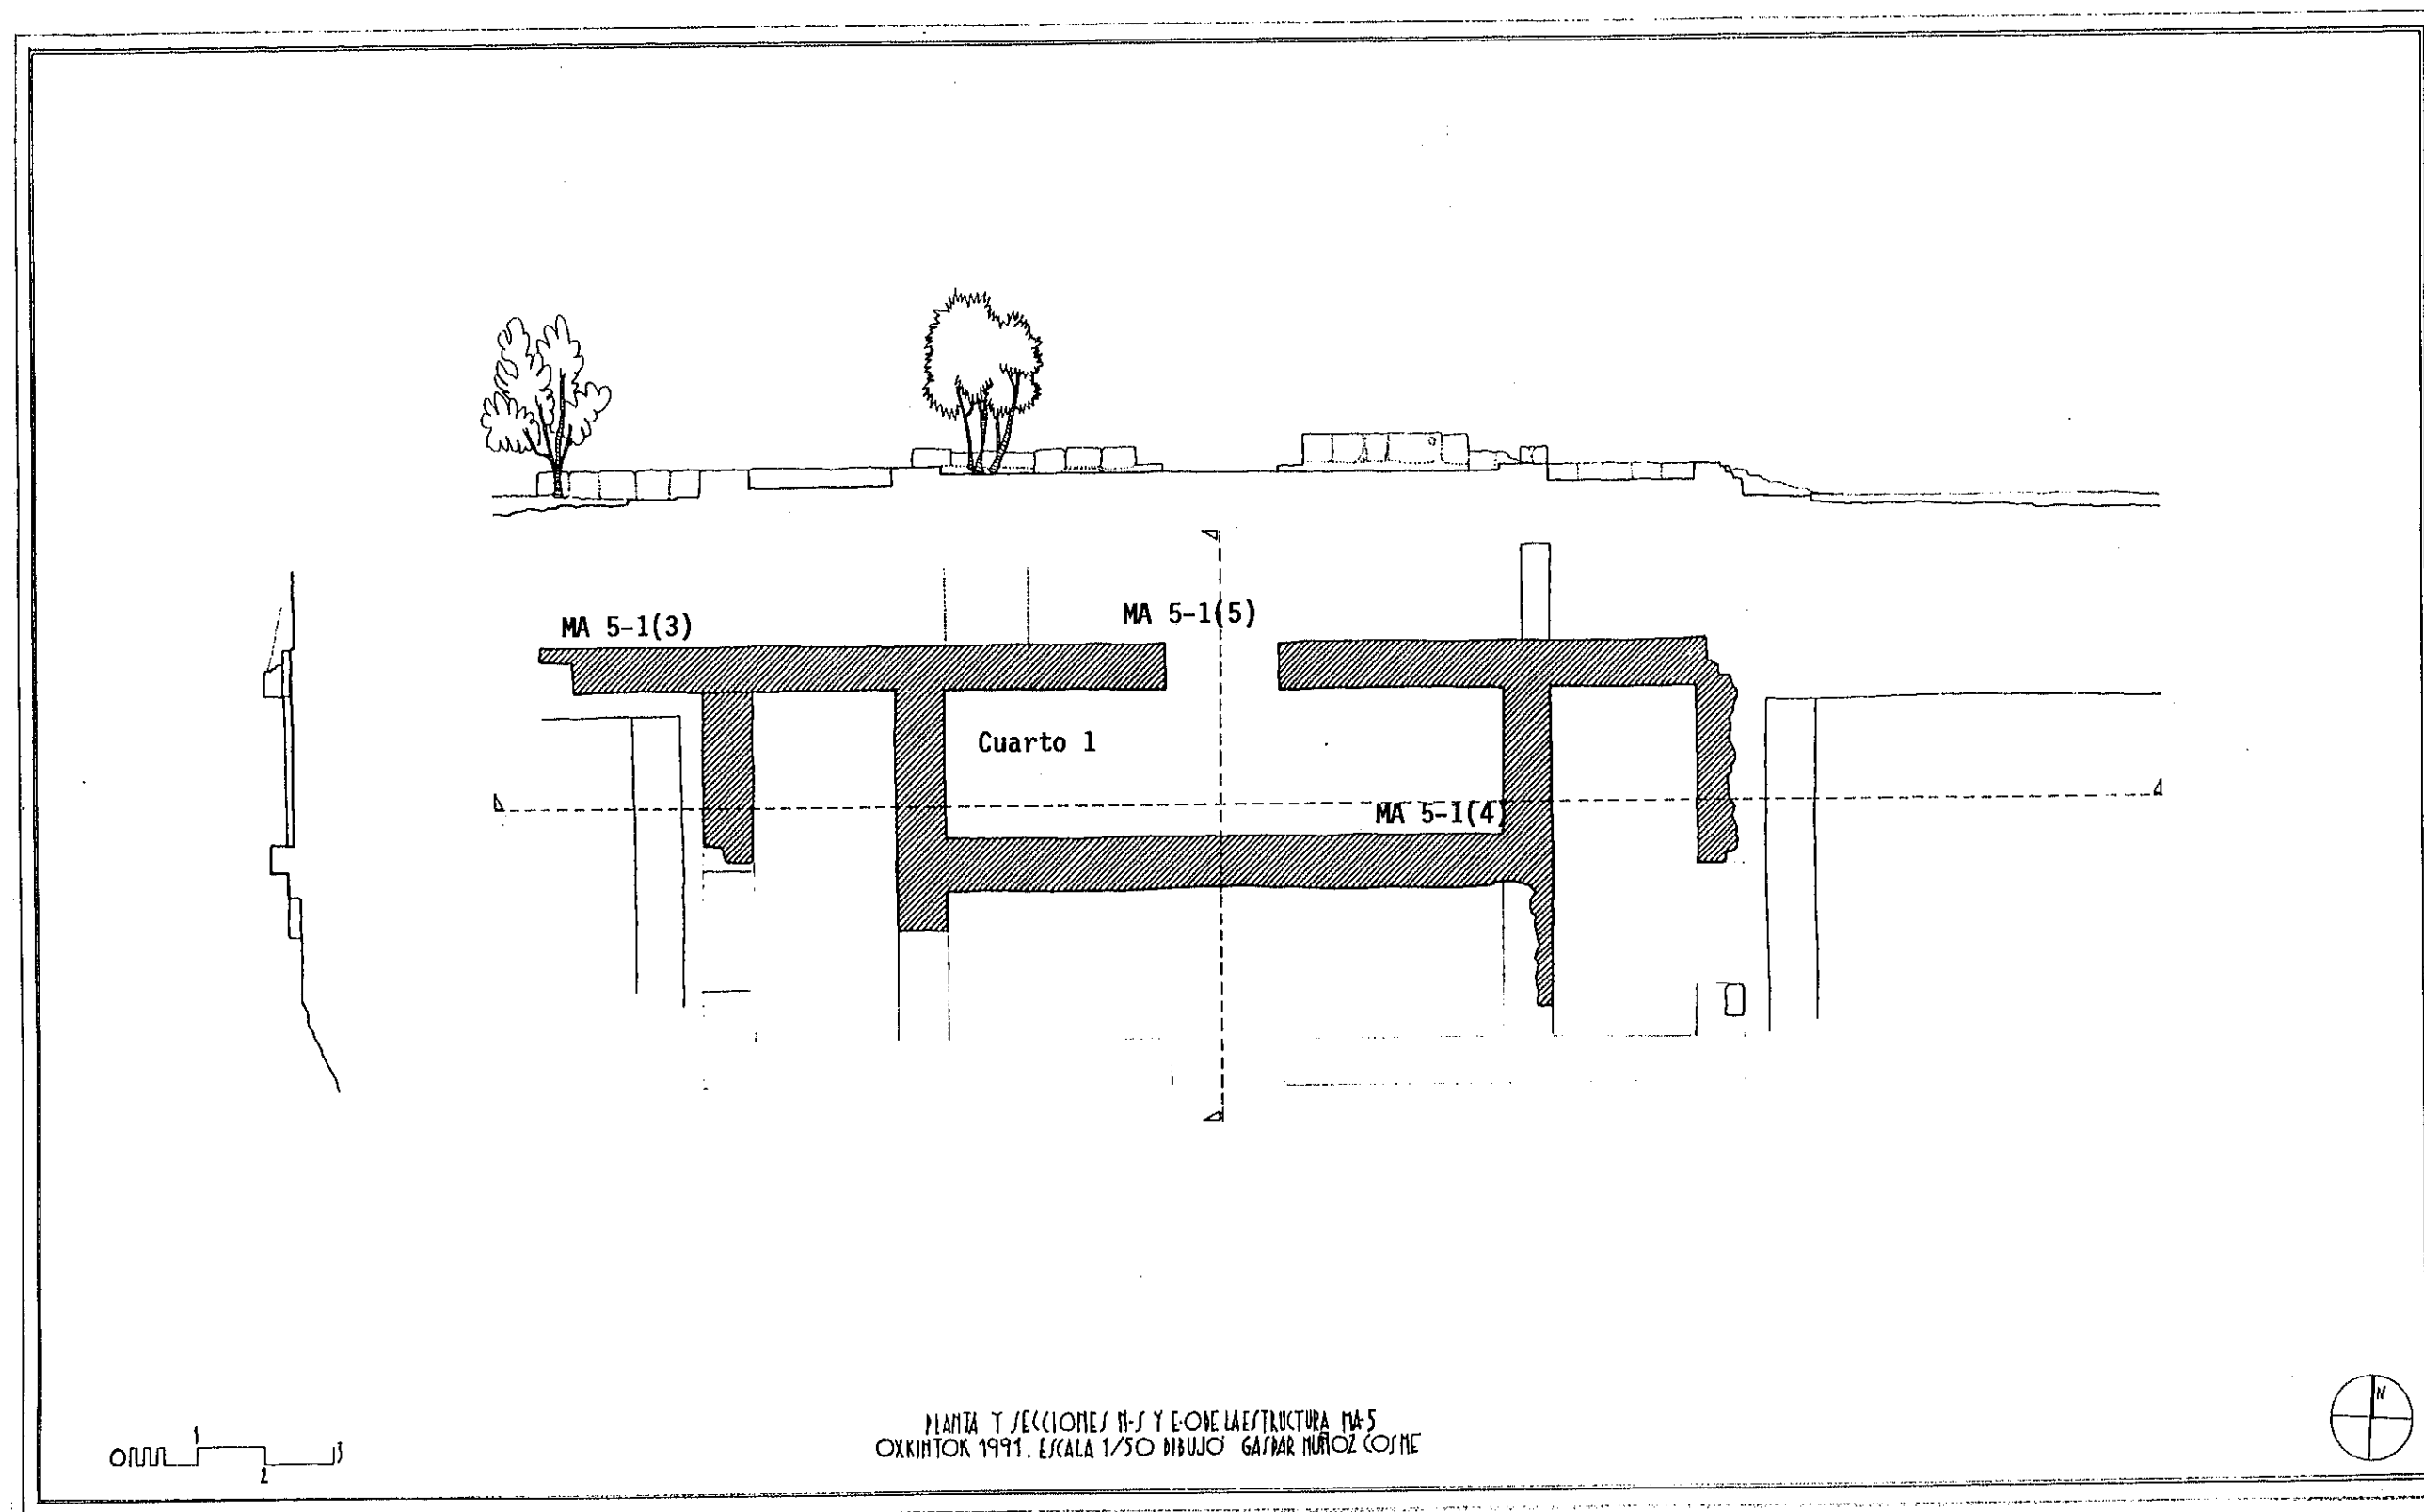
Planta y secciones de la estructura MA-5. Aparecen indicadas las suboperaciones realizadas en esta estructura.
